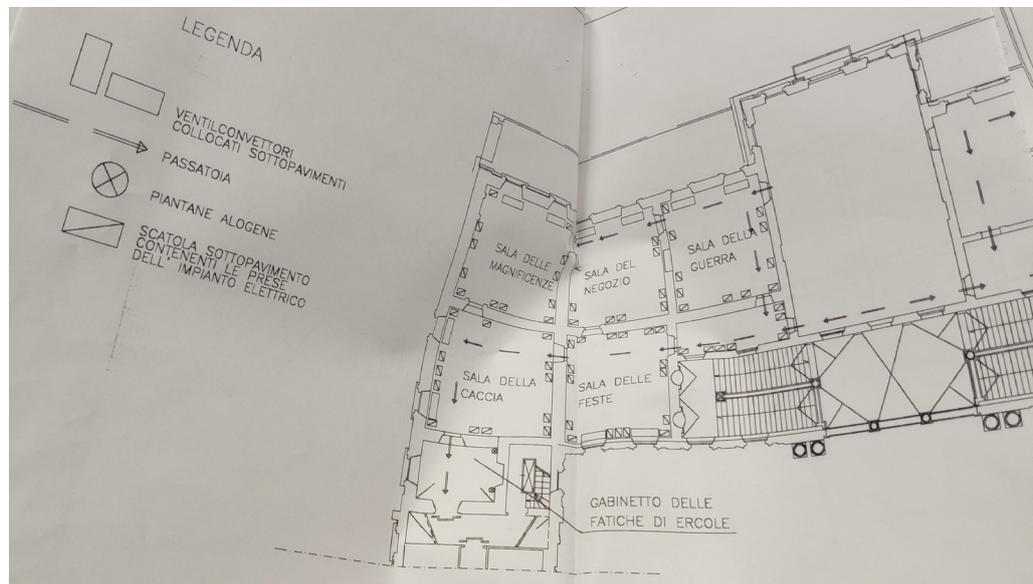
Stralcio della pianta con la collocazione dei nuovi impianti. 2000
